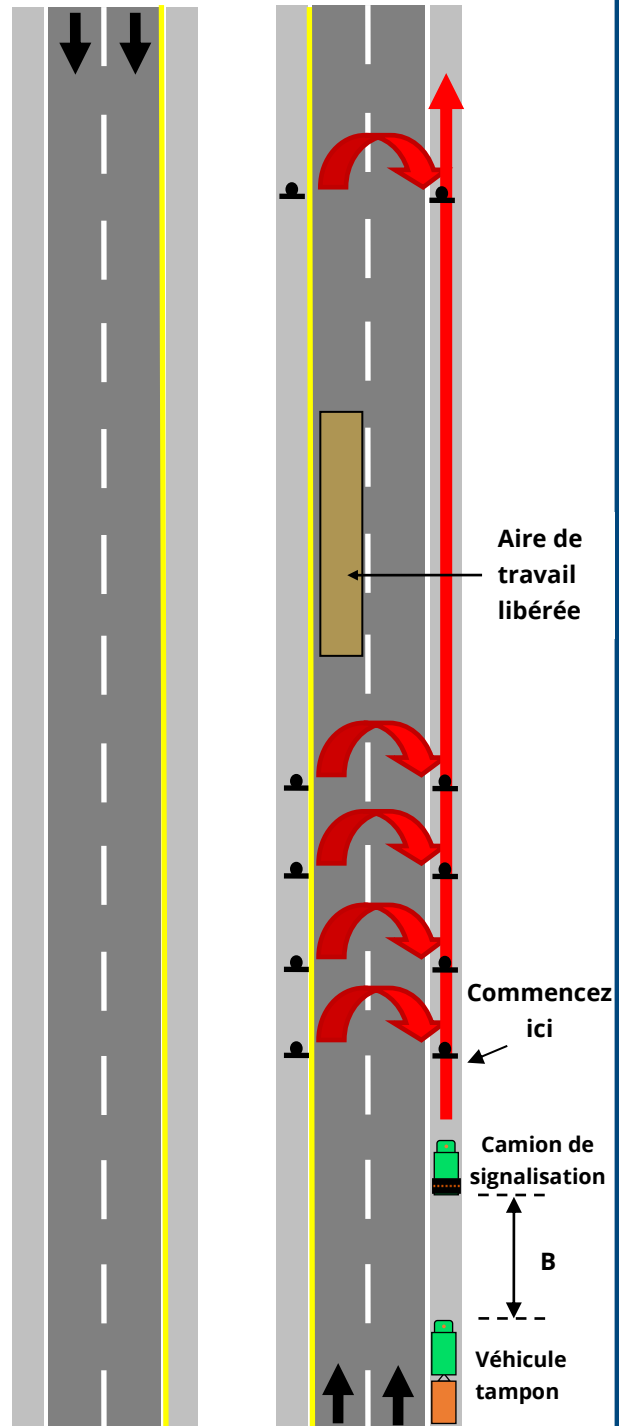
Enlèvement des panneaux (routes à voies multiples à chaussées séparées)
